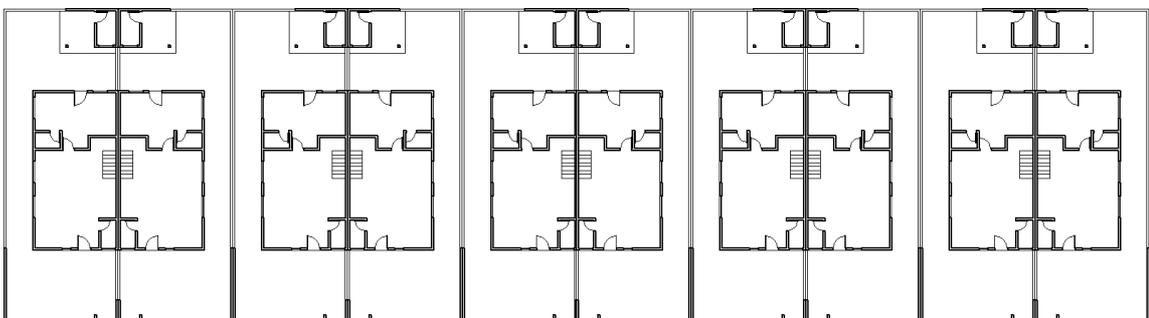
Planta de implantação de 10 casas geminadas com edícula
